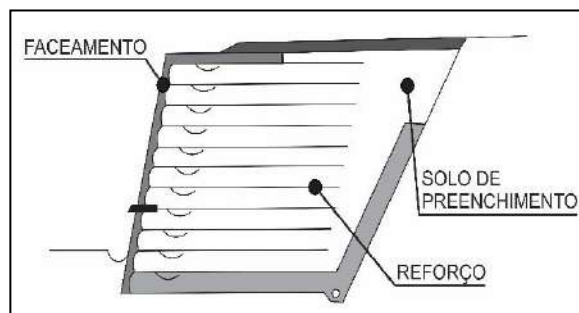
Seção transversal de um muro de solo reforçado (Ehrlich; Becker, 2009).
